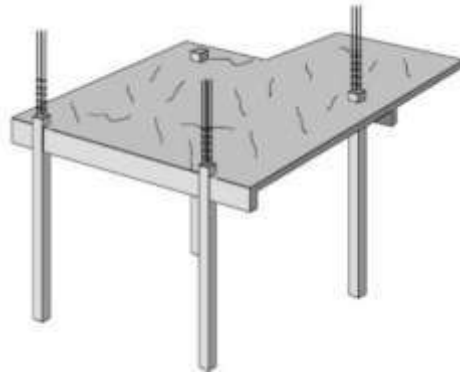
Fisuras de retracción plástica en losa de estructura.
